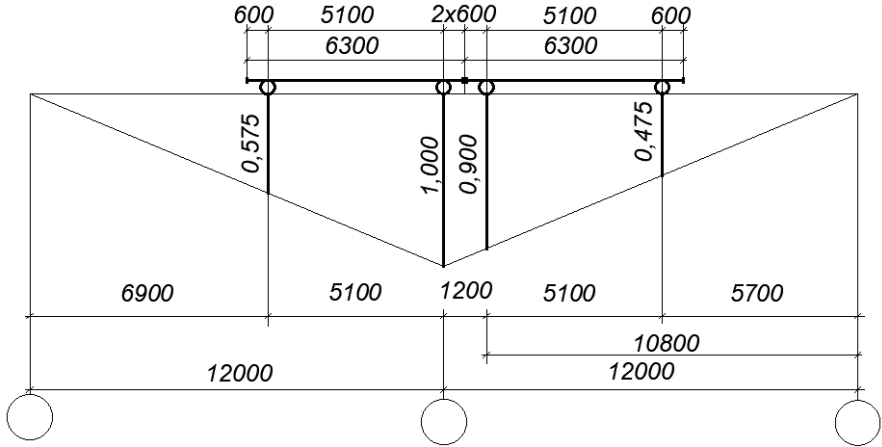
Схема для визначення вертикальних кранових навантажень від двох зближених кранів на середню колону
